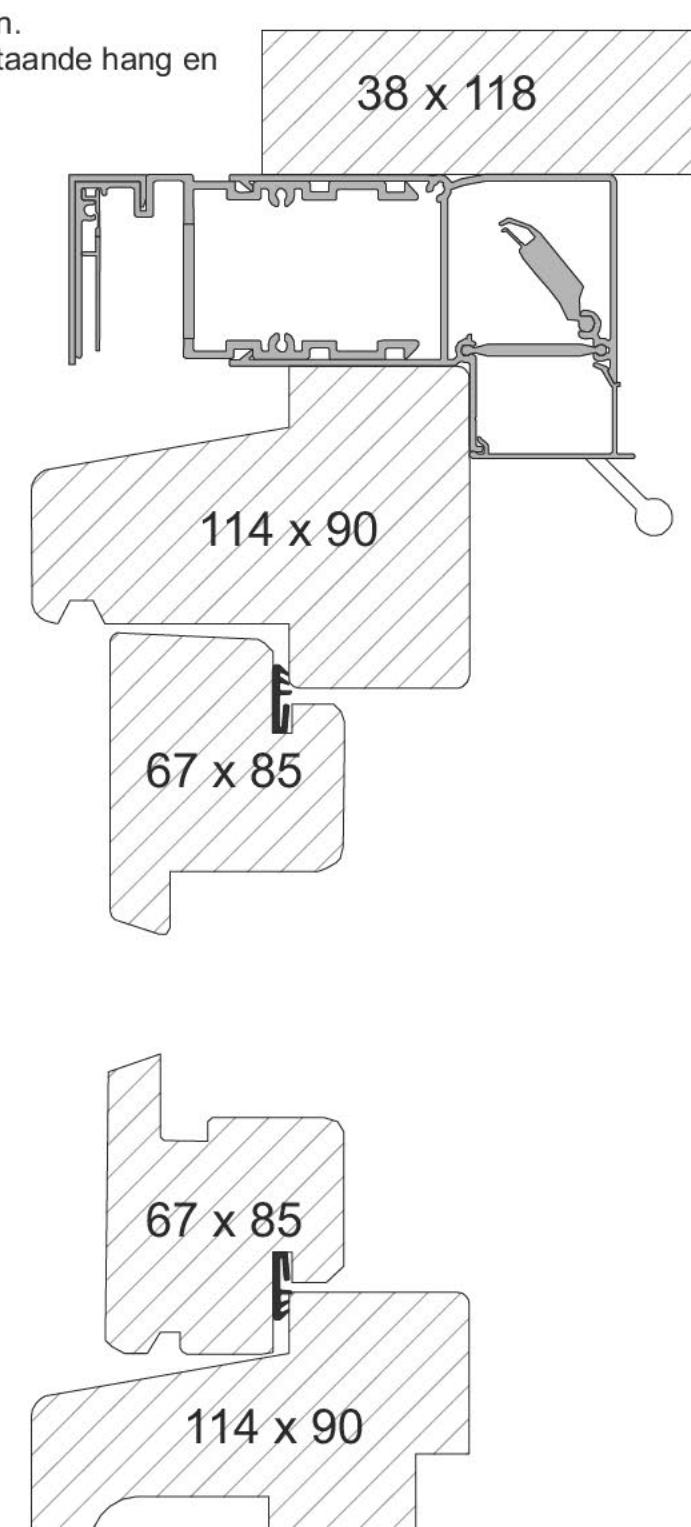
principe detail kozijn, aansluiting dubbelglas - nieuwe toestand
